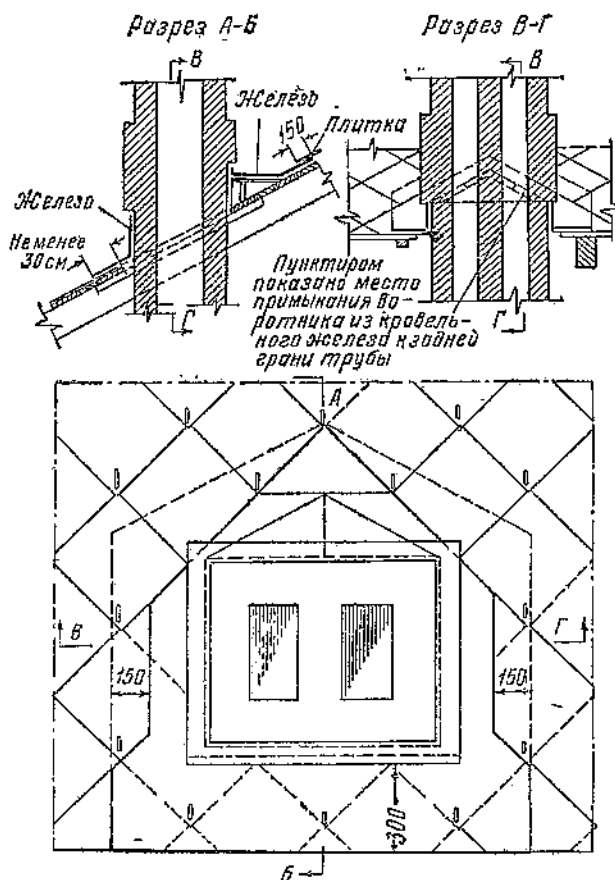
Примыкание плиточного покрытия к дымовым трубам.
